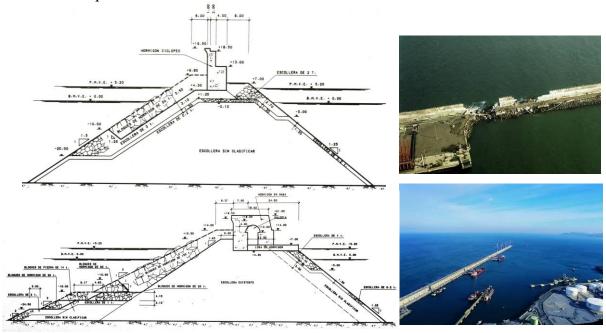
Dique Punta Lucero. Puerto de Bilbao. Secciones tipo: primitiva y reforzada. Panorámicas: avería y estado actual.
